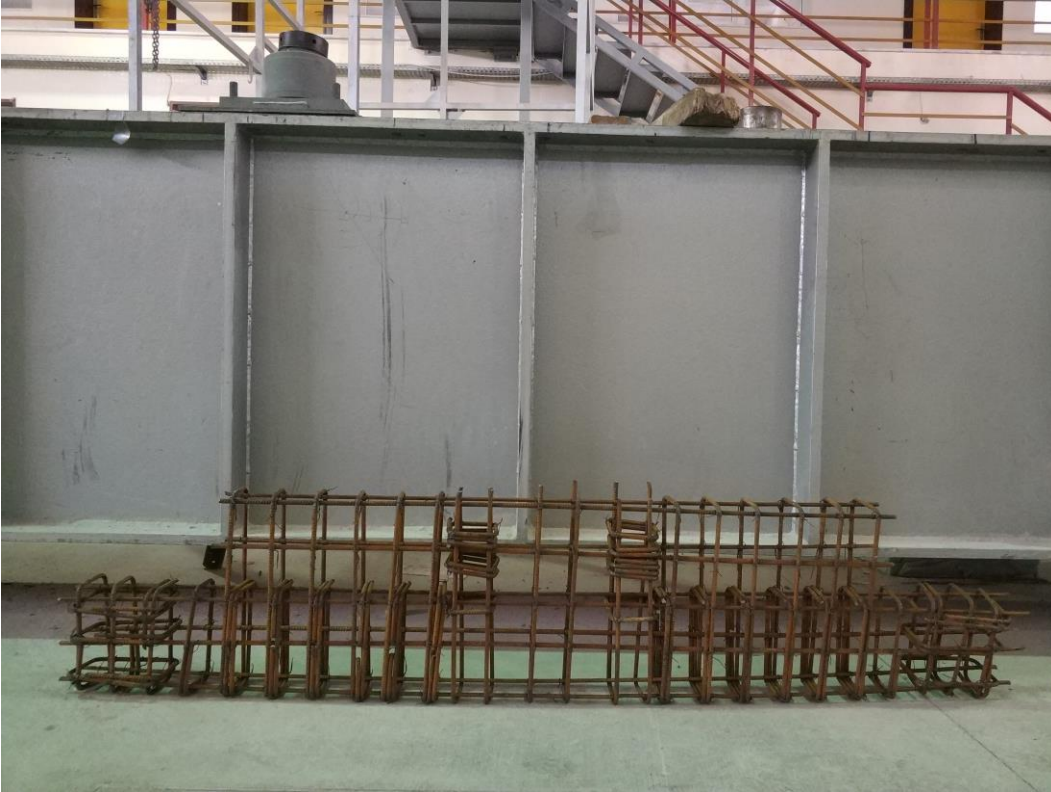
Deney Elemanı - 1 kesit A-A
